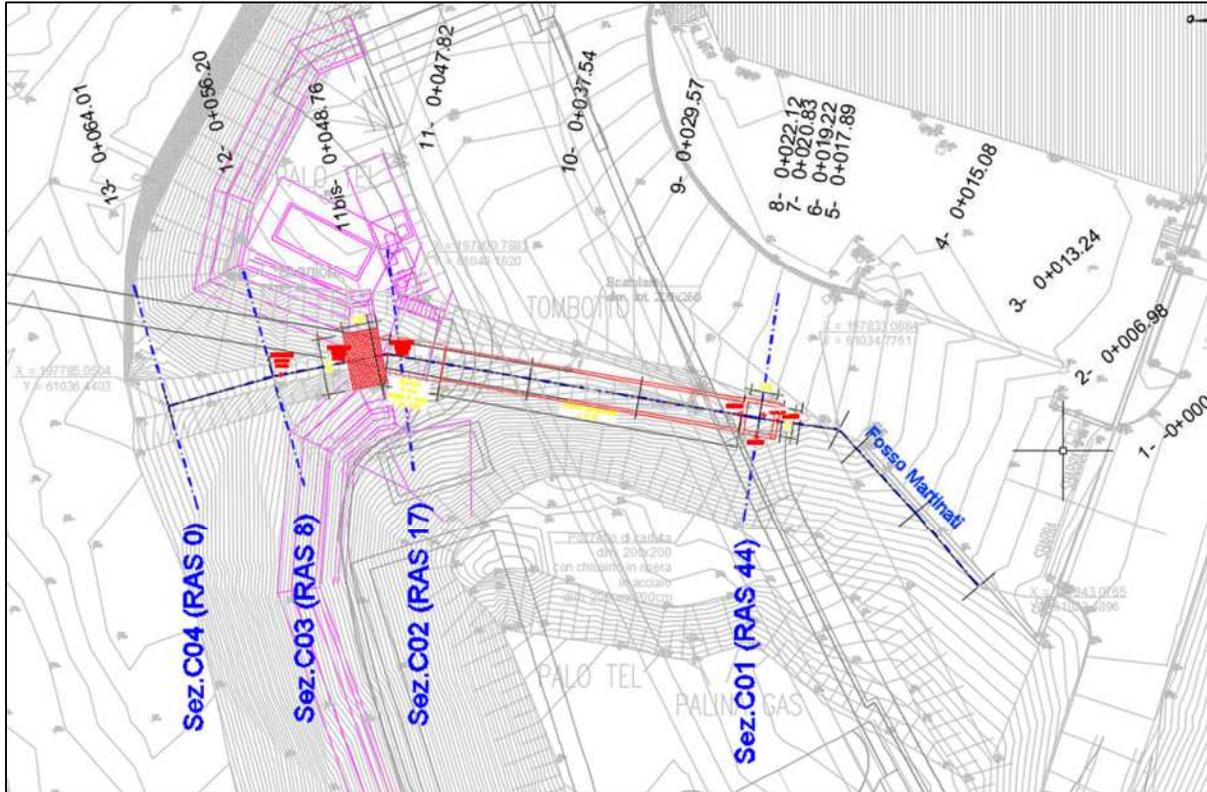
Fosso Martinati – Planimetria e indicazione sezioni RAS
